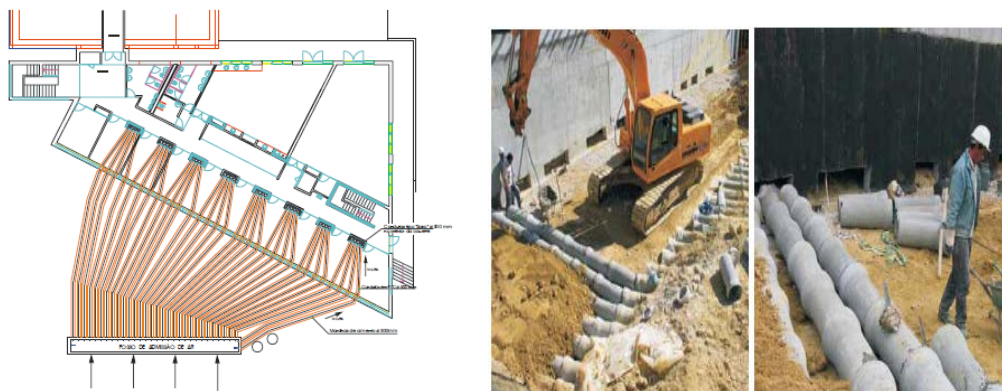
Vista em planta do sistema de tubos enterrados e visualização dos tubos em cimento de diâmetro 300 mm (Adaptado de Gonçalves e Cabrito, 2004).
